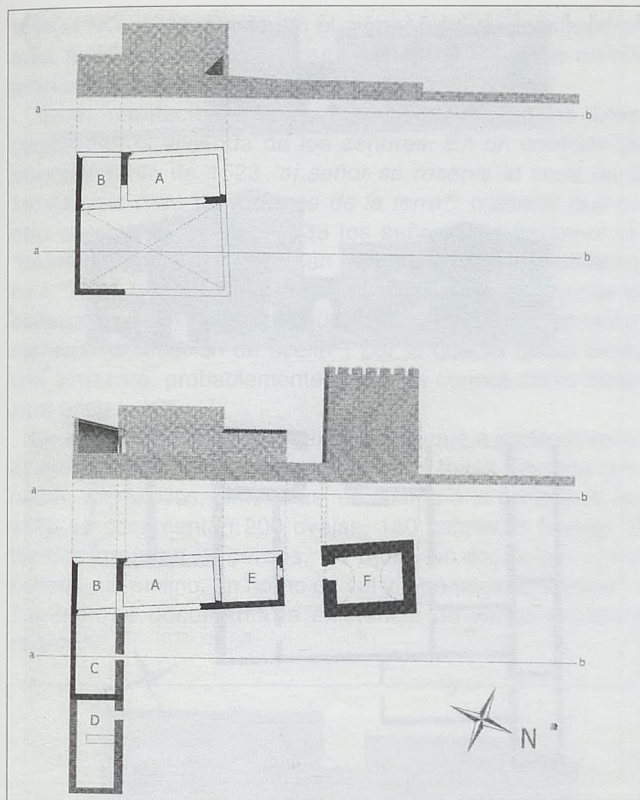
Reconstrucción hipotética de las casas de la alquería Beniorella en el s. XIV: en la planta y sección de arriba se representa el estado anterior a 1320. En la planta y sección de abajo, vemos la fase en la que se empezaron a adosar las barracas y otras casas con el muro de cerramiento del patio ya derruido. También se puede ver la hipótesis de la torre en su estado primitivo. En planta se representan las barracas en distinto tono de gris, la «D» parece ser la de Joan Antoni «Grec» de 1323.
